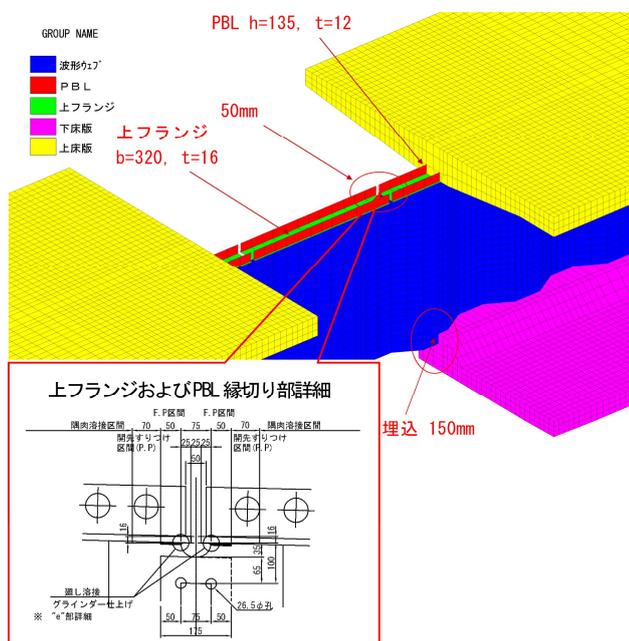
閉合部施工時の張出しブロック先端ひび割れ発生イメージ図
